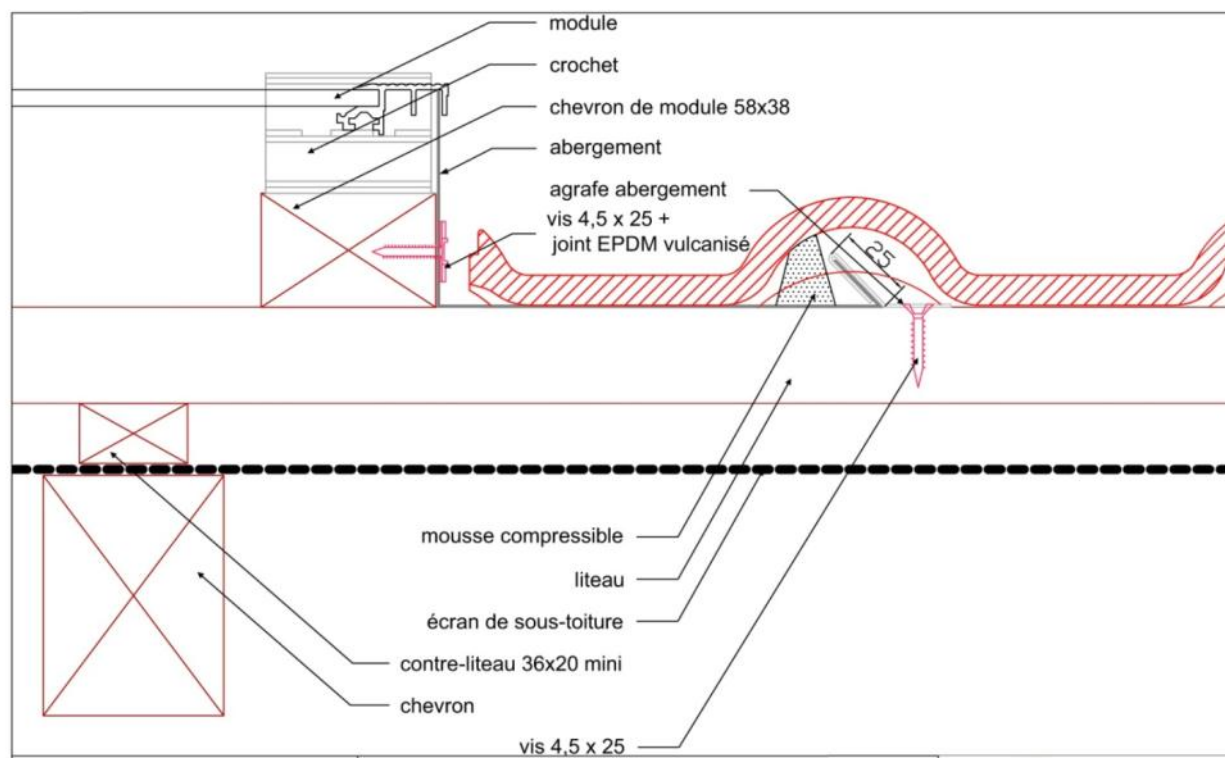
Coupe longitudinale de l'abergement haut (avec ou sans voliges)
